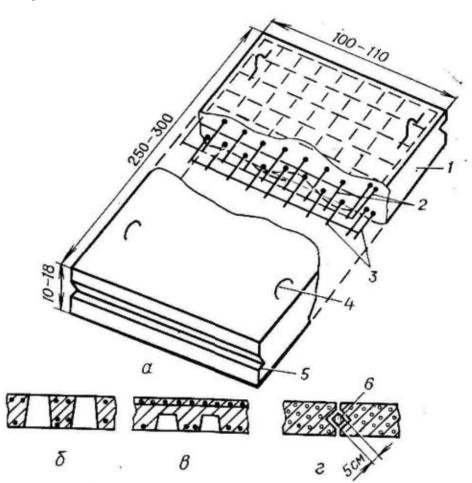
Плита сборно-разборного железобетонного покрытия: а — общий вид (сверху арматура обнажена); б — деталь поперечного сечения решетчатой плиты; в — деталь поперечного сечения яченстой плиты; в — деталь стыка плит; 1 — бетов; 2 — верхняя (распределительная) арматура; 3 — нижняя (рабочая) арматура; 4 — монтажная петля; 5 — треугольный торцевой выем; 6 — деревянный стыковой брусок
